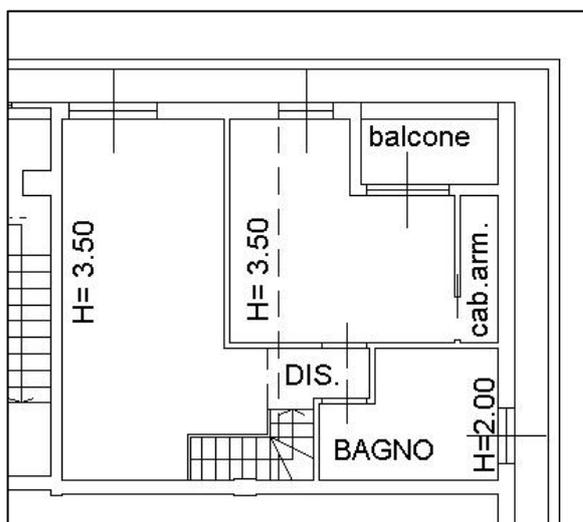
Planimetria catastale 31.12.2009 - Piano.3°
